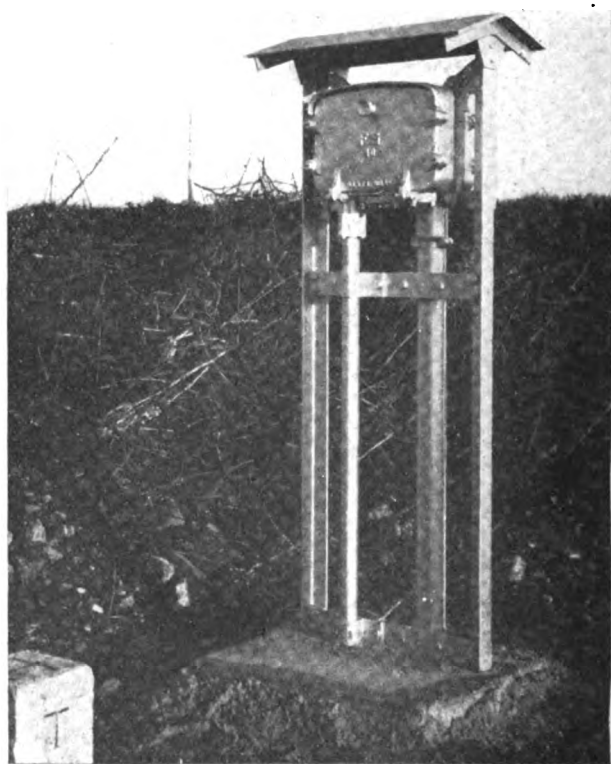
Sistemazione di cassette di sezionamento su piantana.
